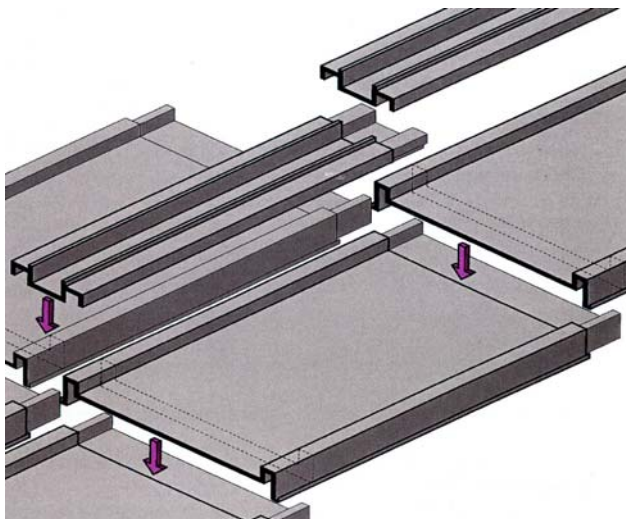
Detalle del solapamiento de las piezas que conforman la cubierta modular.
